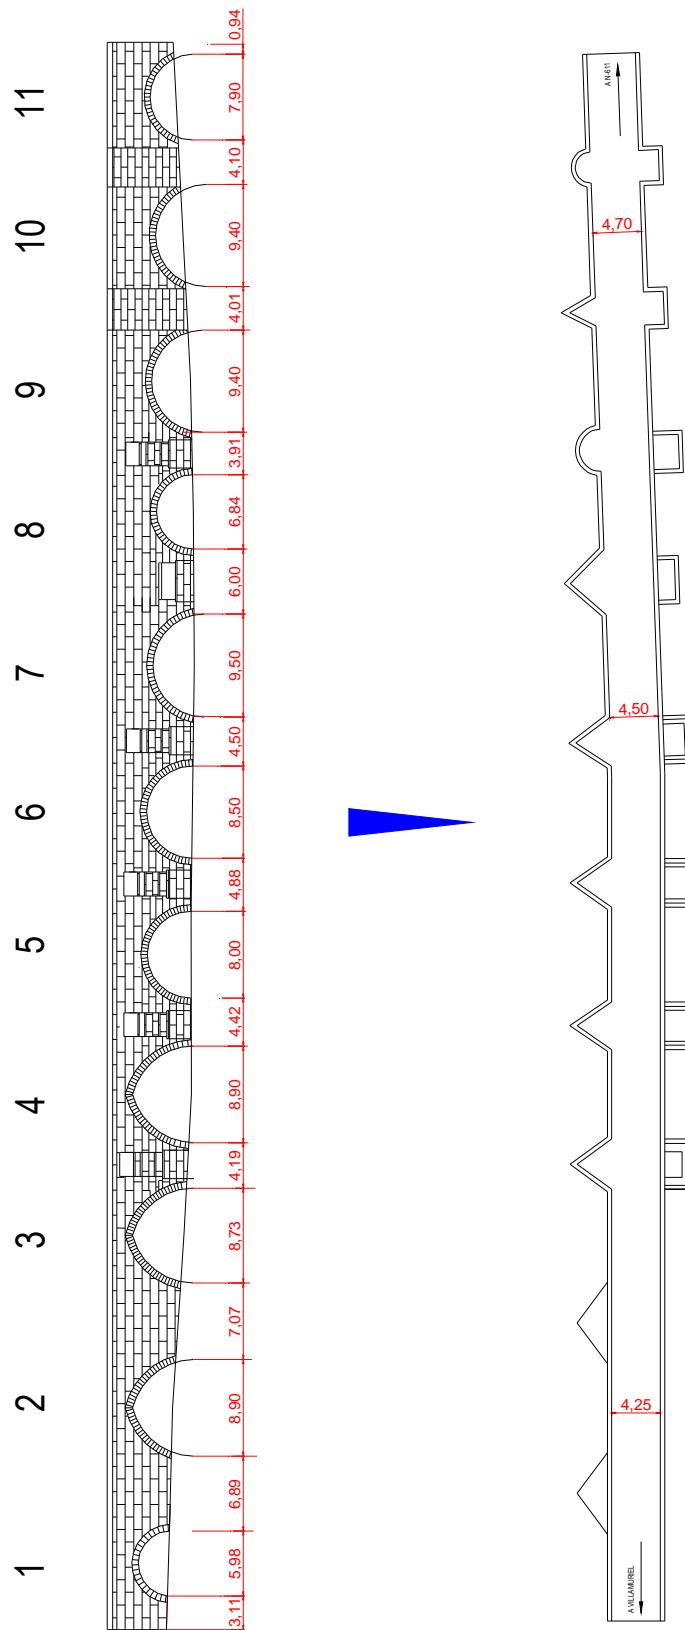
Planta y alzado de aguas abajo del puente en Villamuriel de Cerrato
